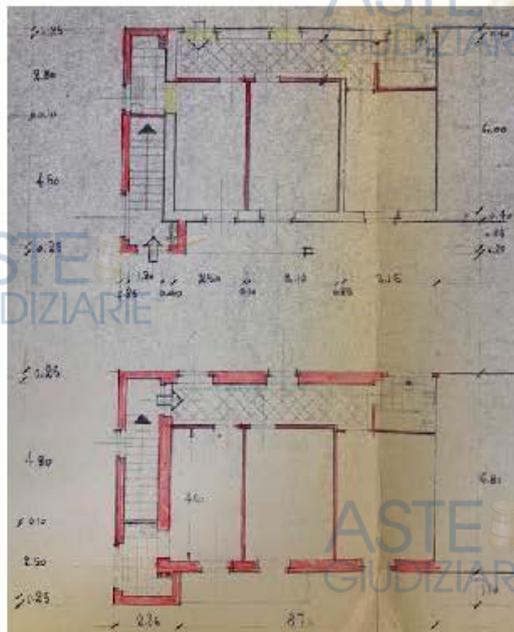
Estratto Autorizzazione 486 del 18/08/1956 (superata) – piante
